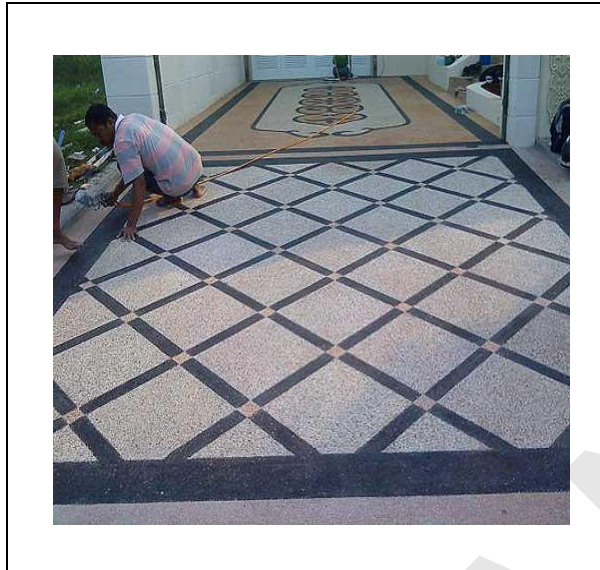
Stamp Concrete (Pola Stamp Tekstur
